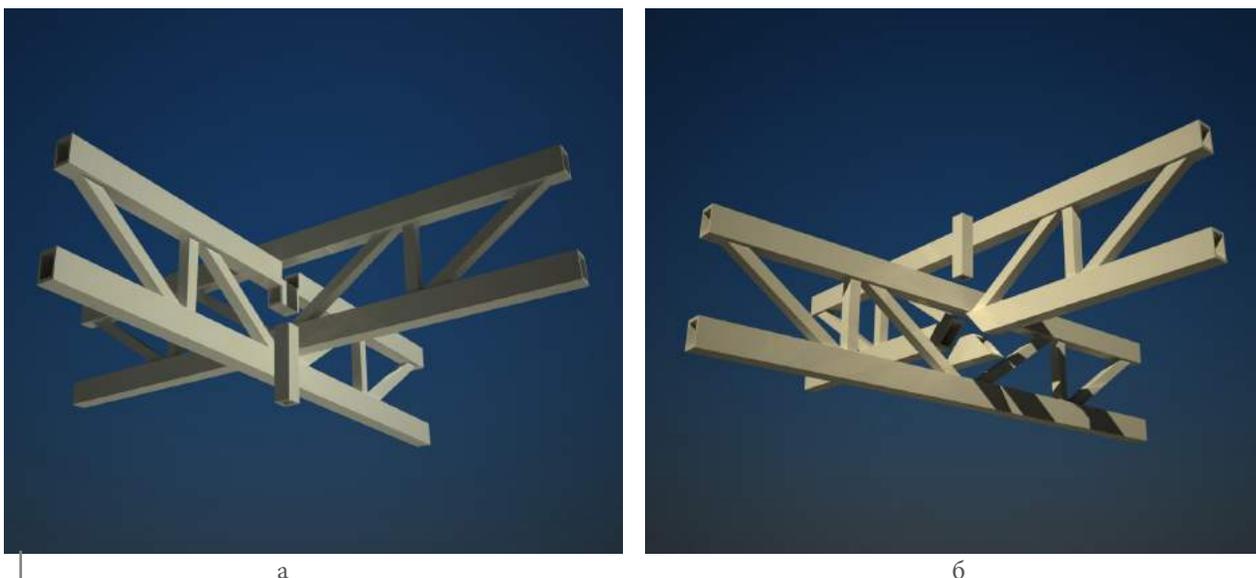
Аксонометрии сопряжений перекрестных ферм с использованием монтажных окон:
